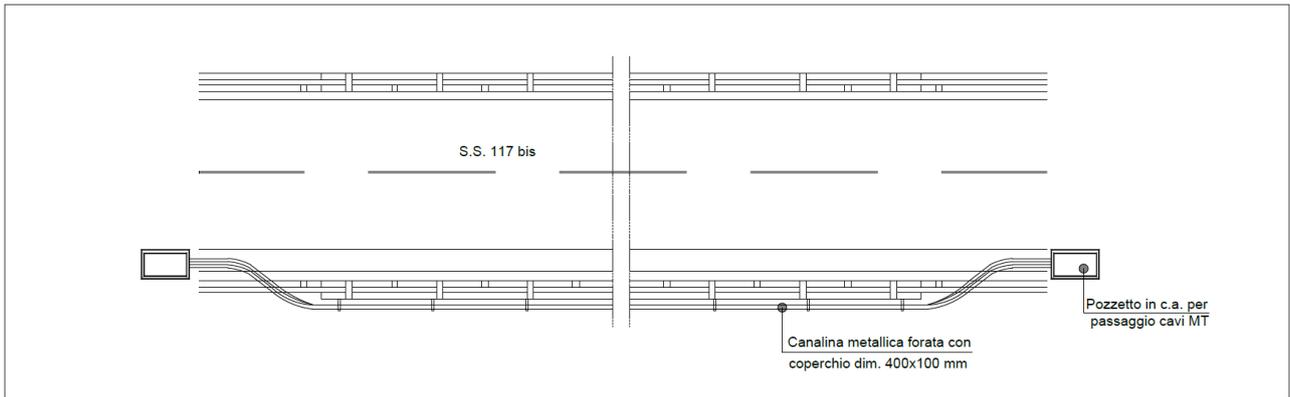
Attraversamenti n.15, 16, 17 – Schema di progetto in pianta
